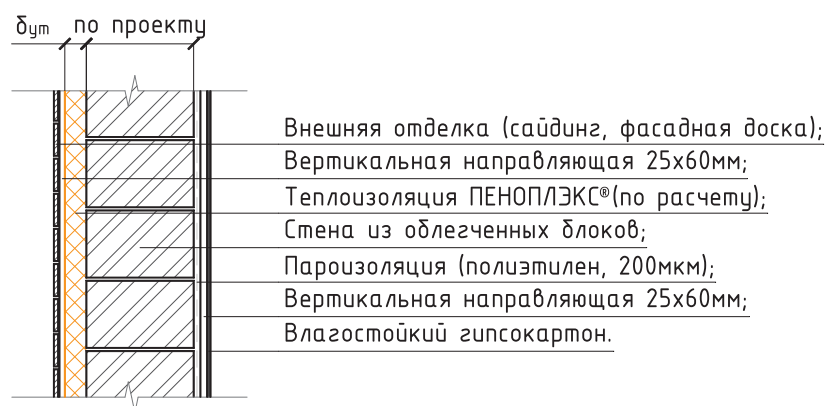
Схема внешней отделки фасадной доской/сайдингом.
